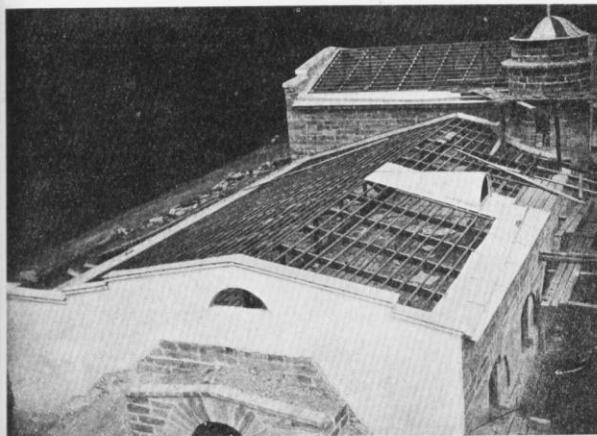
Подвалъ Станції. Выполнены плотничныя работы по устройству крыши. Двухэтажная часть подвала перекрыта двускатной крышей ст. подвѣсной системой стропиль., ст. бабкой, подкосами и затяжкой. Стропила одноэтажной части — наслонные; по стропиламъ сдѣлана обрешетка подъ черепицу изъ брусковъ (латъ). Выполняются кровельныя работы оцинкованнымъ желѣзомъ по покрытию ендово, пеленъ, надѣтъныхъ желобовъ, покрытие башни и проч.
